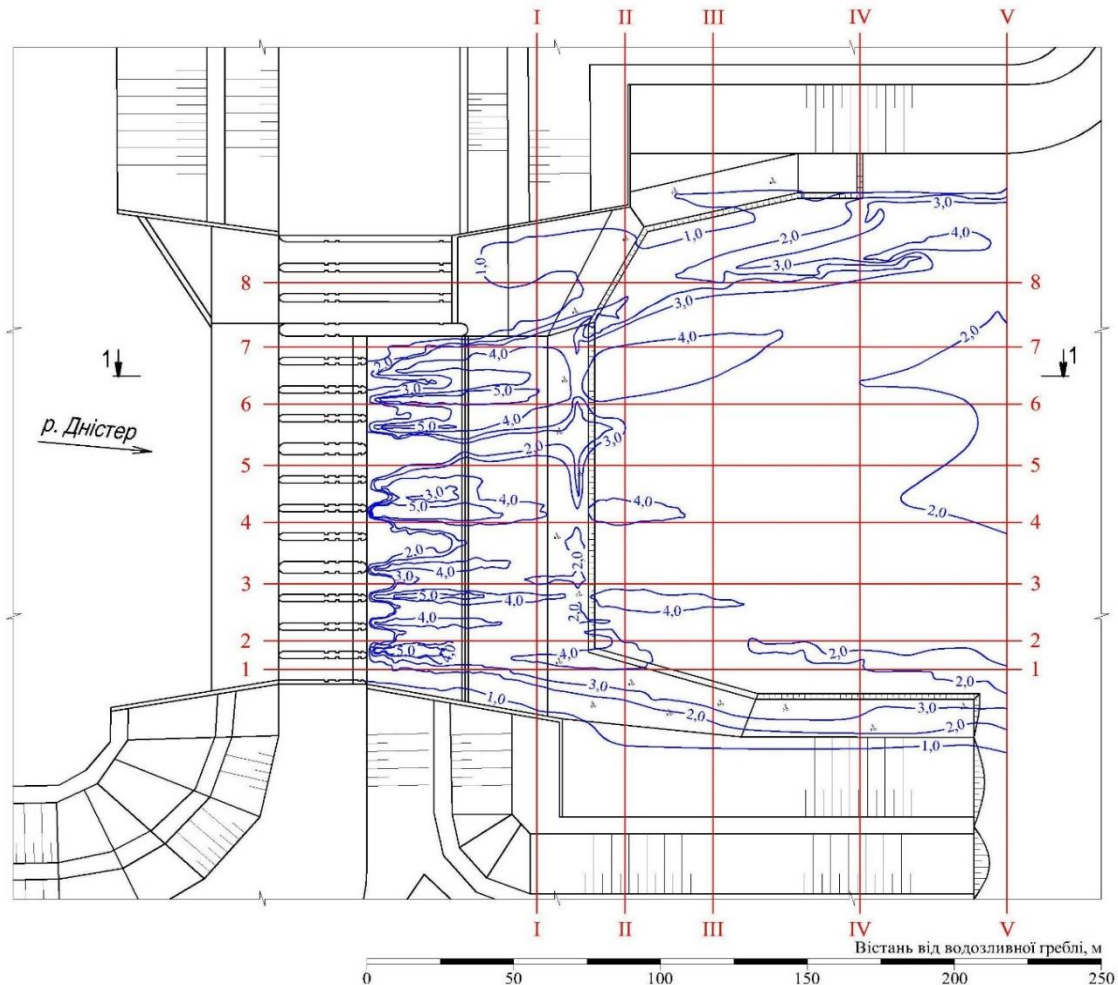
План розміщення поперечних та поздовжніх перерізів в нижньому б'єфі. Усереднений в часі розподіл швидкості (план-розріз на відмітці +65,000 м)
